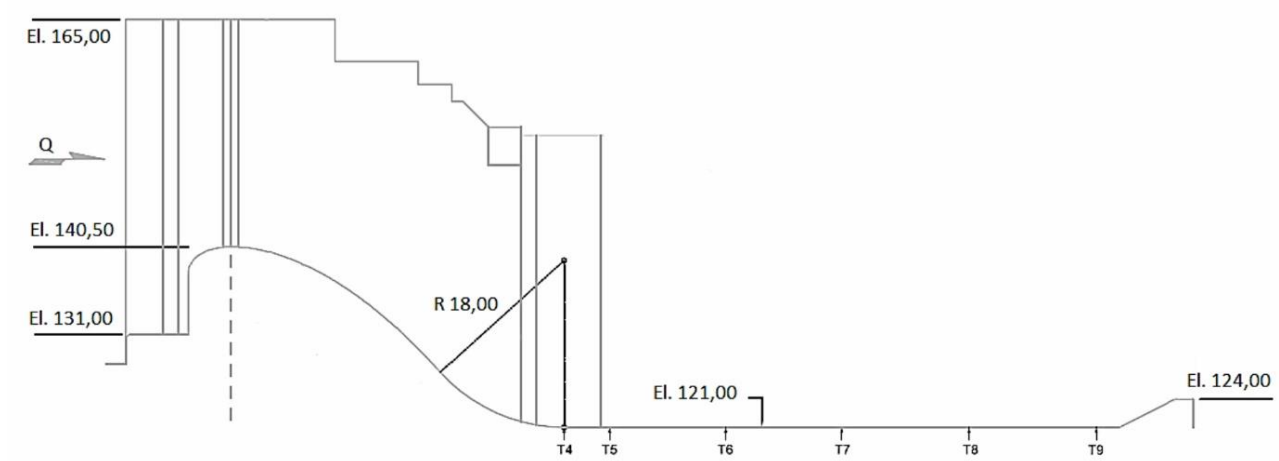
Perfil longitudinal do modelo da UHE São Manoel e posição das tomadas de pressão. Fonte: Hampe (2018).
